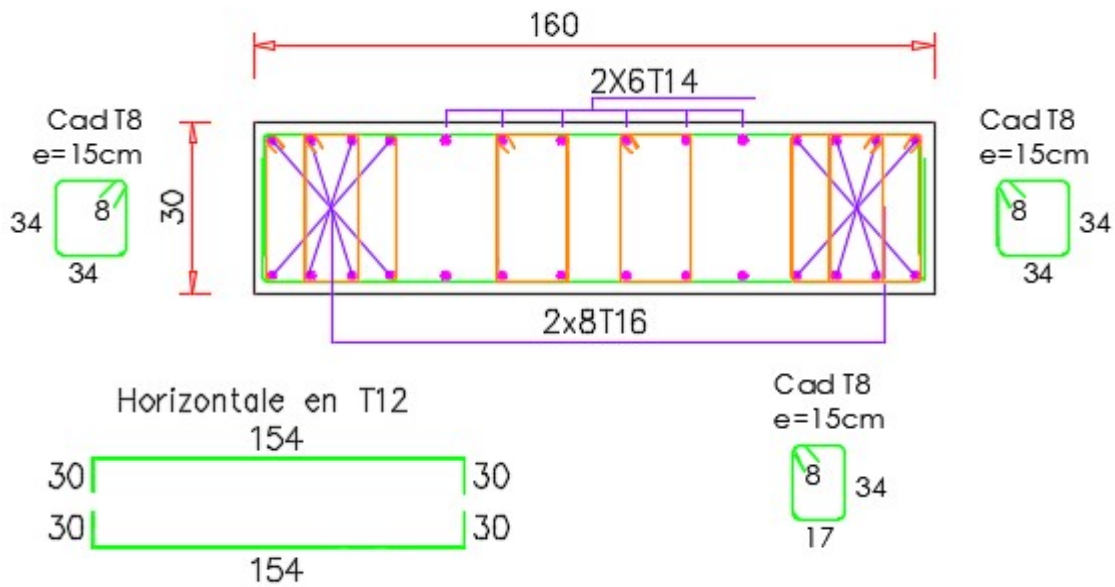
Schéma de ferrailage pour les voiles de longueur L= 1.60m.
